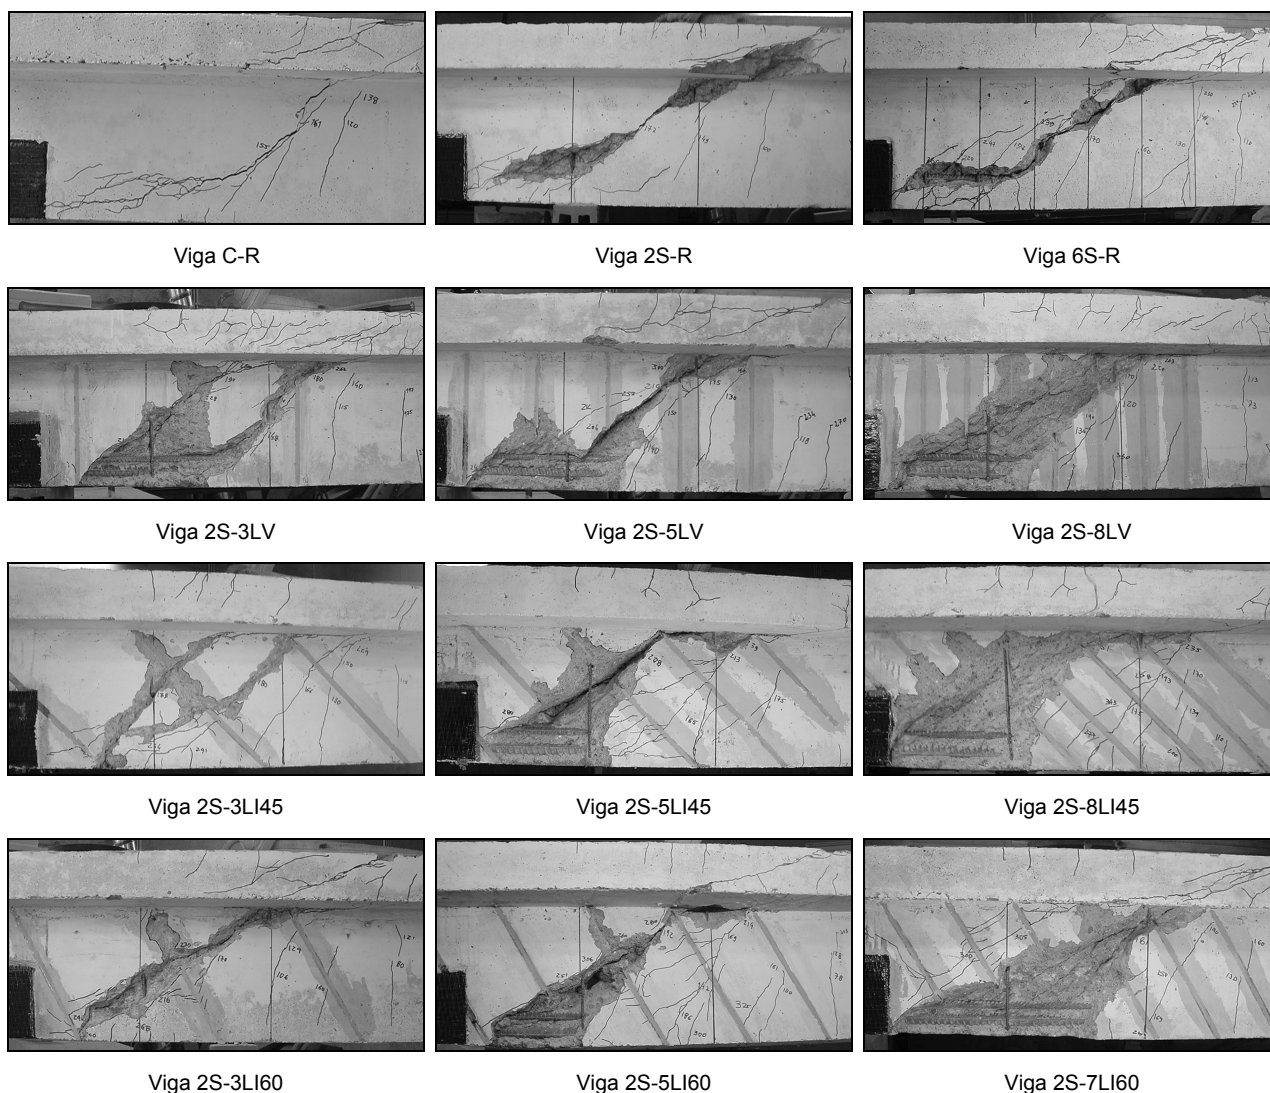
Pormenorização da zona de rotura das vigas ensaiadas
